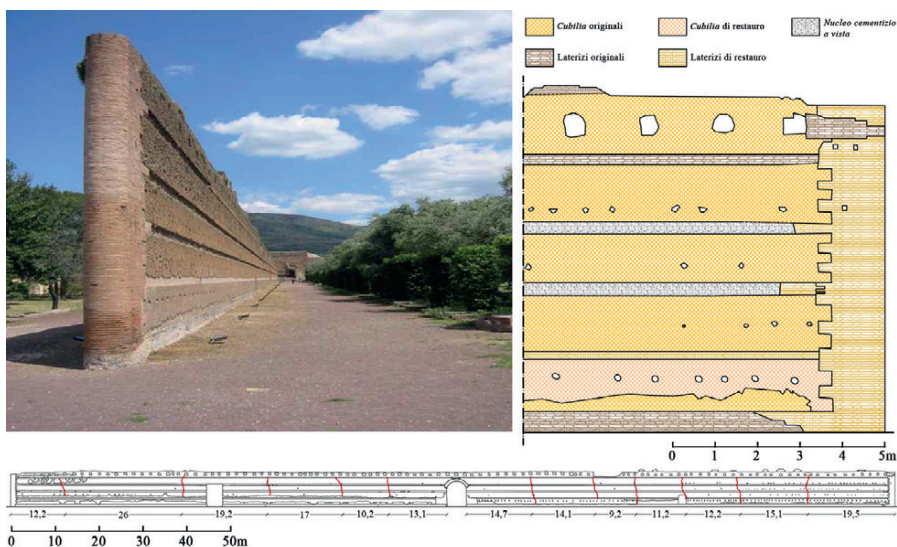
Villa Adriana, muro di spina del Pecile: (in alto a sinistra) vista del prospetto sud; (in alto a destra) dettaglio del rilievo del prospetto nord con caratterizzazione delle tecniche esecutive; (in basso) rilievo del prospetto nord con evidenziati le tracce delle riprese di getto. (Rilievo RiVA, resp. Cinque G.E., 2011)
